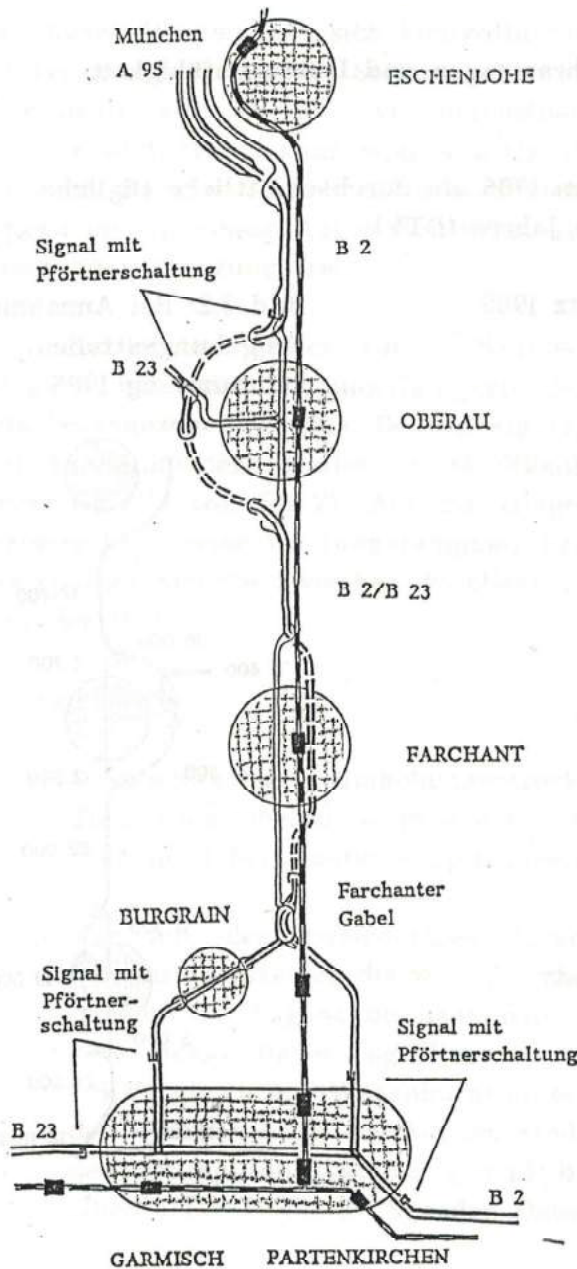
Vor Fertigstellung von Kramertunnel und Wanktunnel
